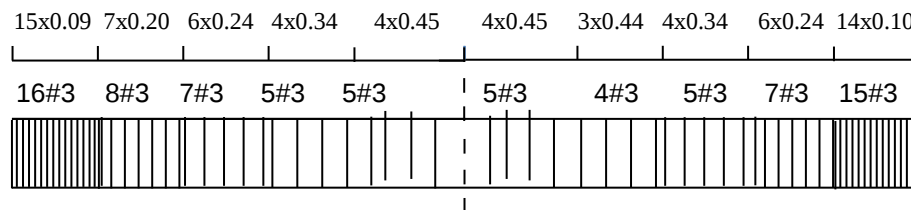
Detalle de la cantidad y posición de los estribos a lo largo de la viga.
